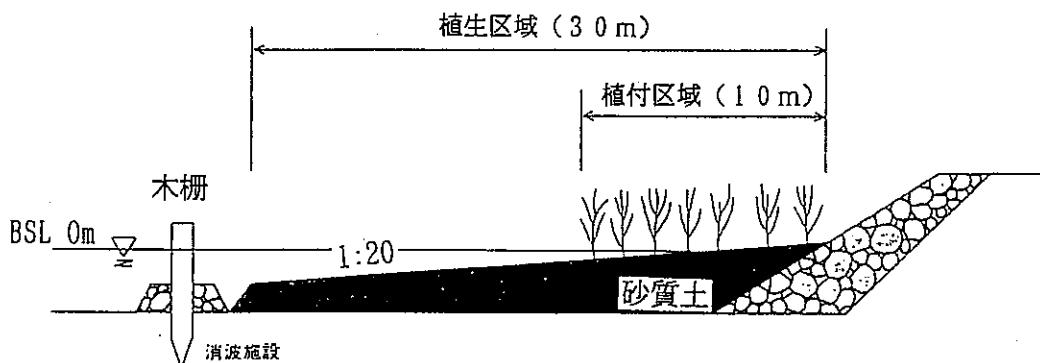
ヨシ植栽地標準断面図（木棚タイプ）
